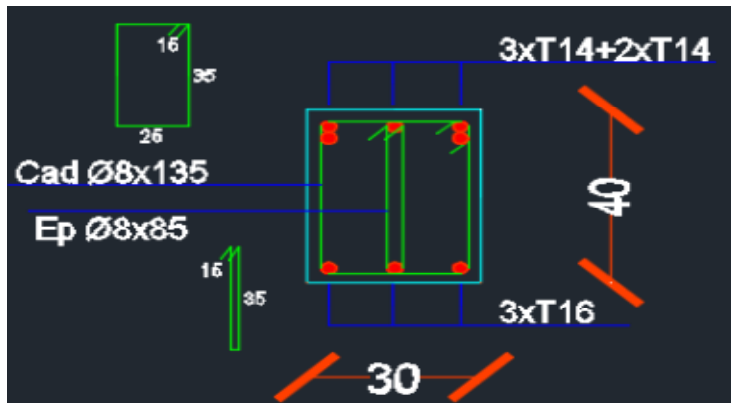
Ferrailage des poutres principales au niveau d'appui
